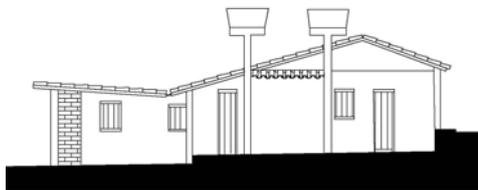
Fachada Leste (Acervo PROAU/FAU/UnB).
